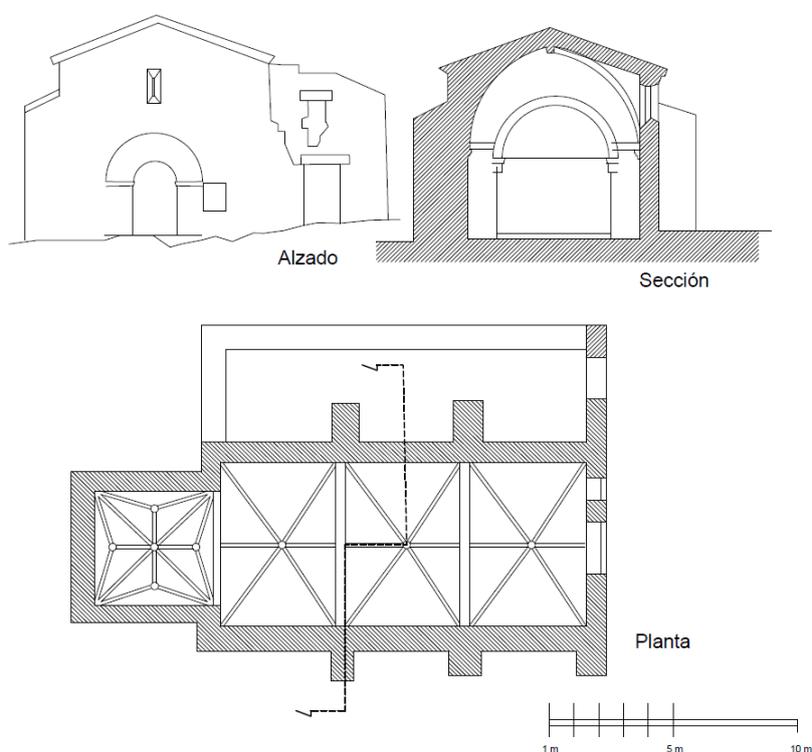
Dibujos del alzado, sección y planta de la Ermita.
